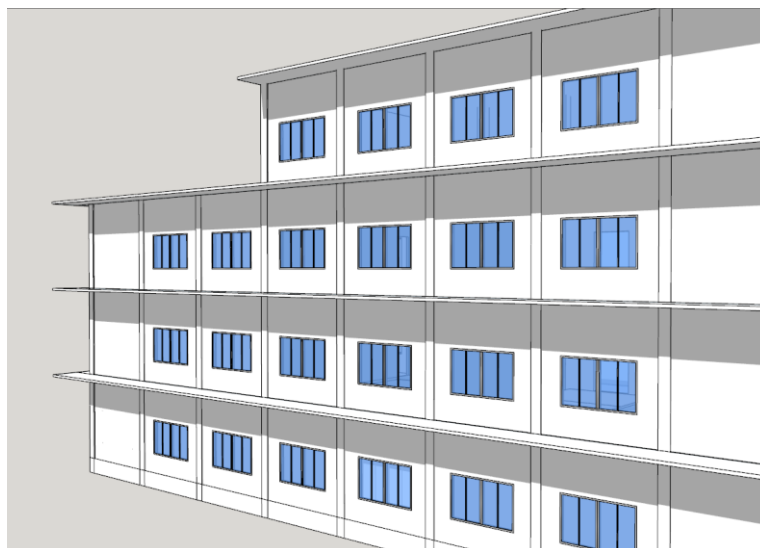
La protection solaire sur la façade est illustrée par une modélisation sketchup en mars à 10h00
